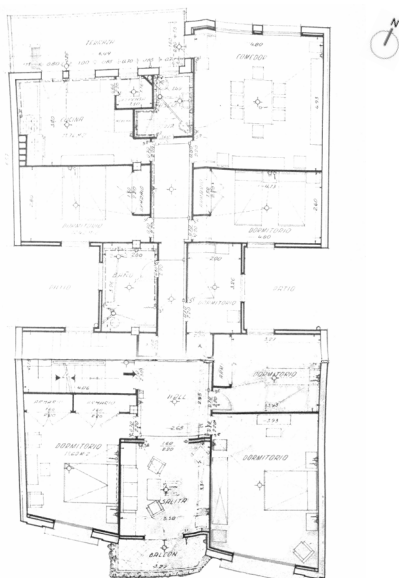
Planta tipo del edificio residencial situado en la rúa Camilo Veiga, 42 (fotografía de autoría propia).
